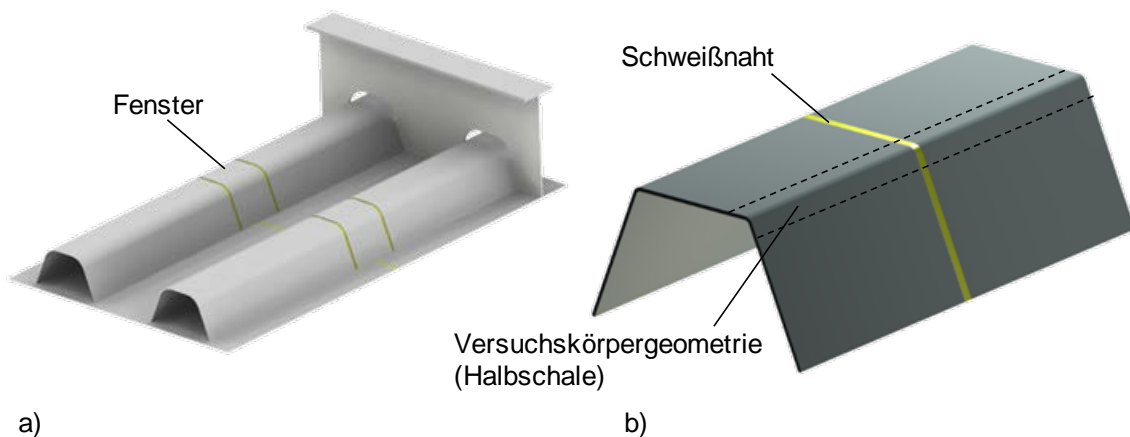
Vollstoß einer Trapezhohlsteife im Brückenbau, a) Darstellung des Bauteils b) Detail des Vollanschlusses
